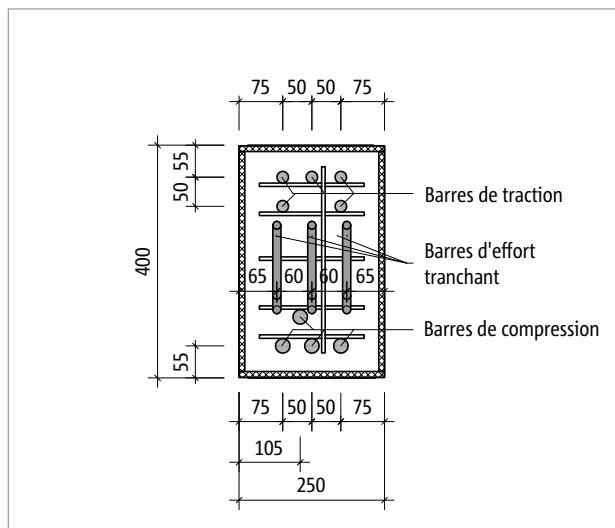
Schöck Isokorb® T Type B-M7-V1 en hauteur H400 : Vue du produit
